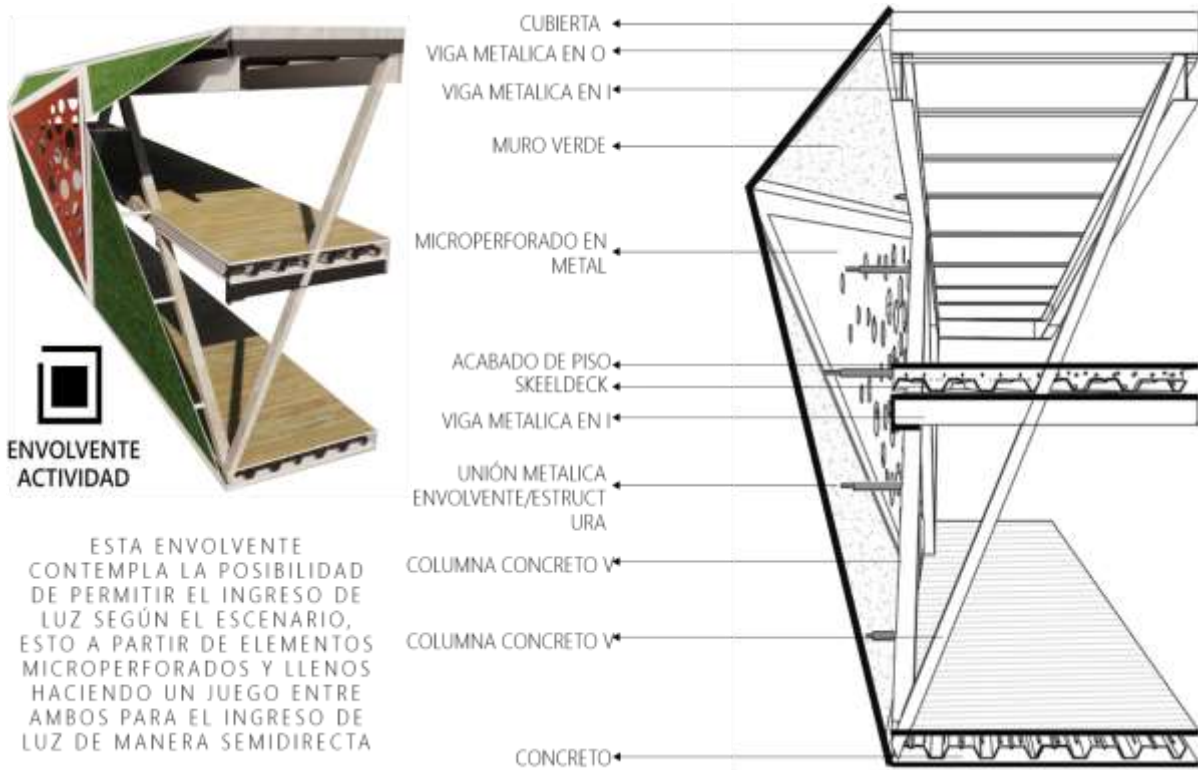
Corte. (Corte fachada Envolverte). Autoría propia.
